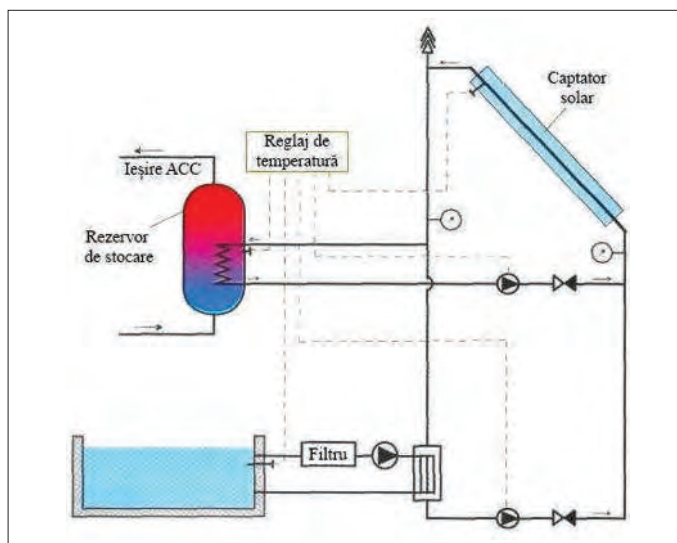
Instalație solară pentru producerea ACC și încălzirea apei din piscină
